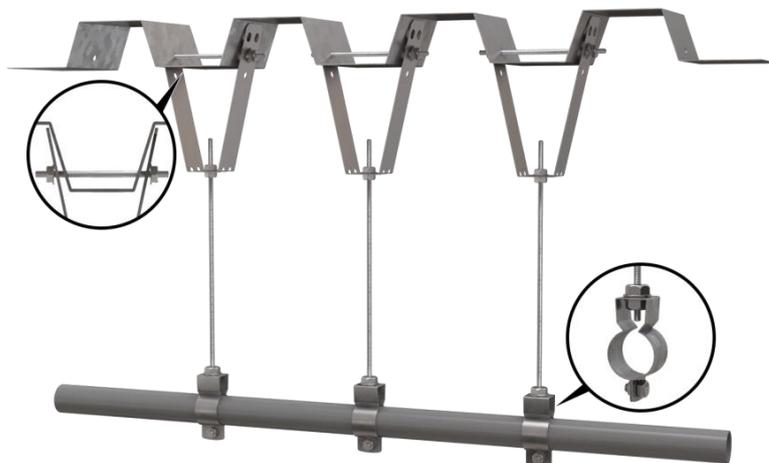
Схема монтажа ОКЛ к перекрытию из профнастила на примере трубы ВГП
